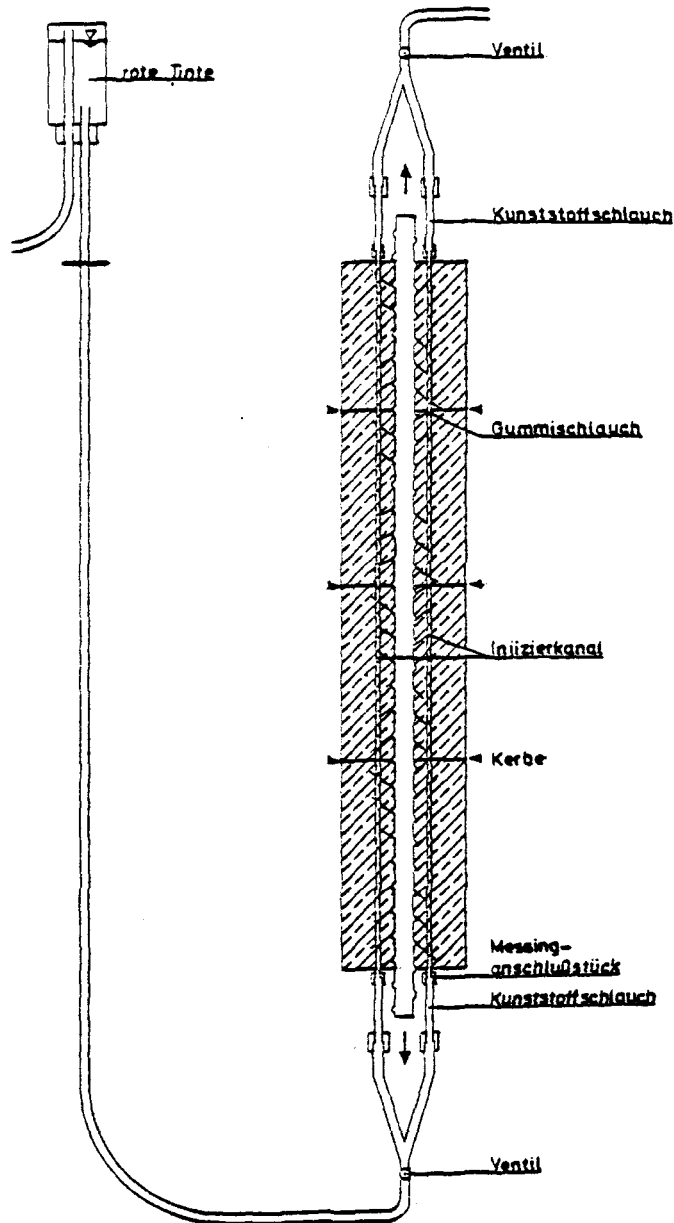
Versuchsaufbau zum Injizieren der Verbundrisse nach Goto /3/
